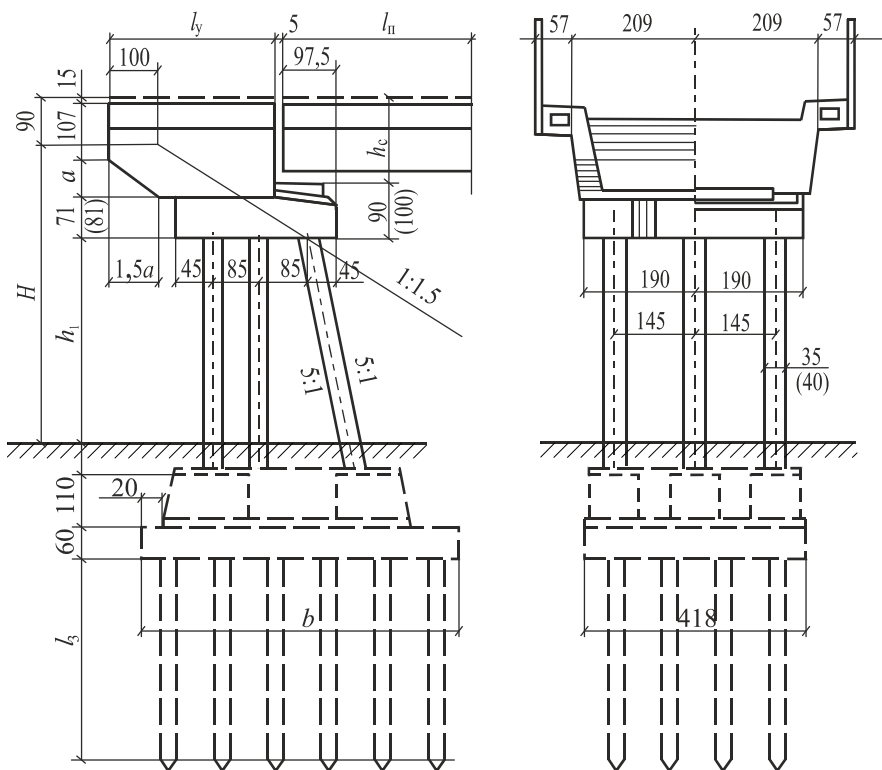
Схема устоя с вариантом свайного фундамента (размеры в скобках при сечении свай 40×40 см)
